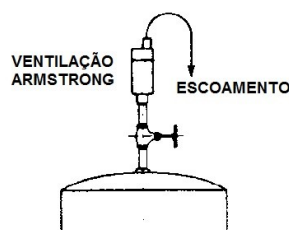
Instalação em ponto alto de um tanque de armazenamento ou de coletas
